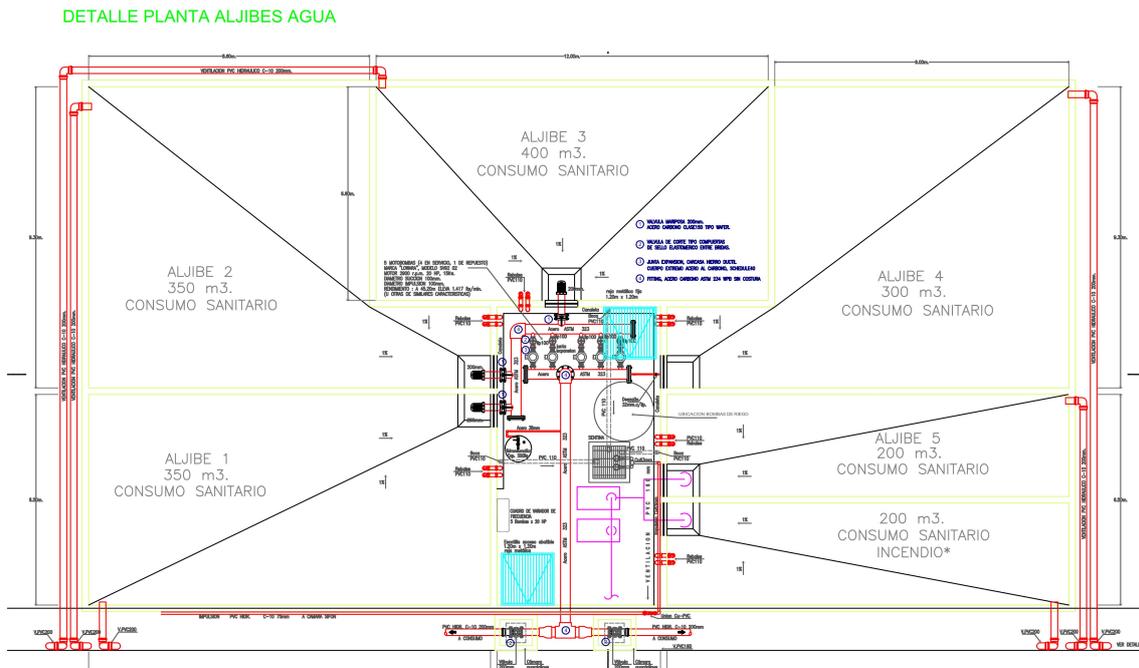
Detalle de la zona de aljibes de AFCH para su almacenamiento y tratamiento. Elaboración propia
